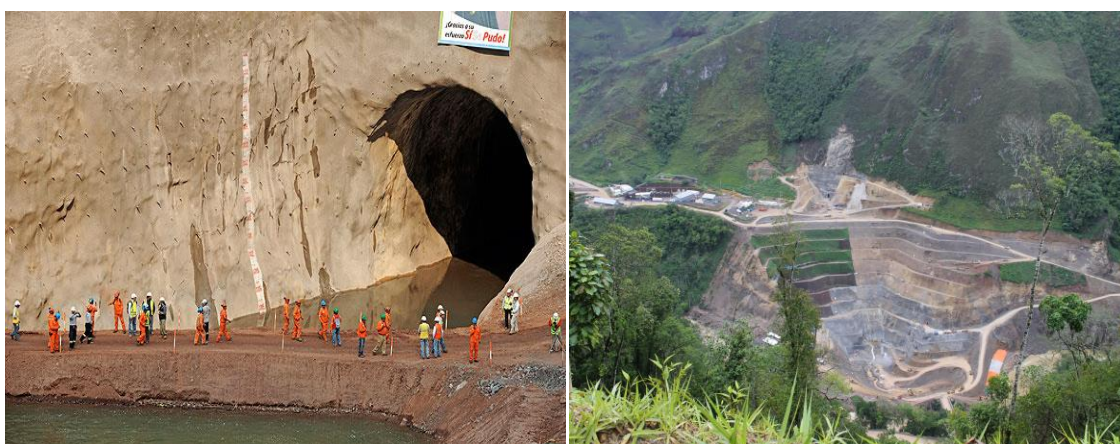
Construcción de la Central Hidroeléctrica de Chaglla
